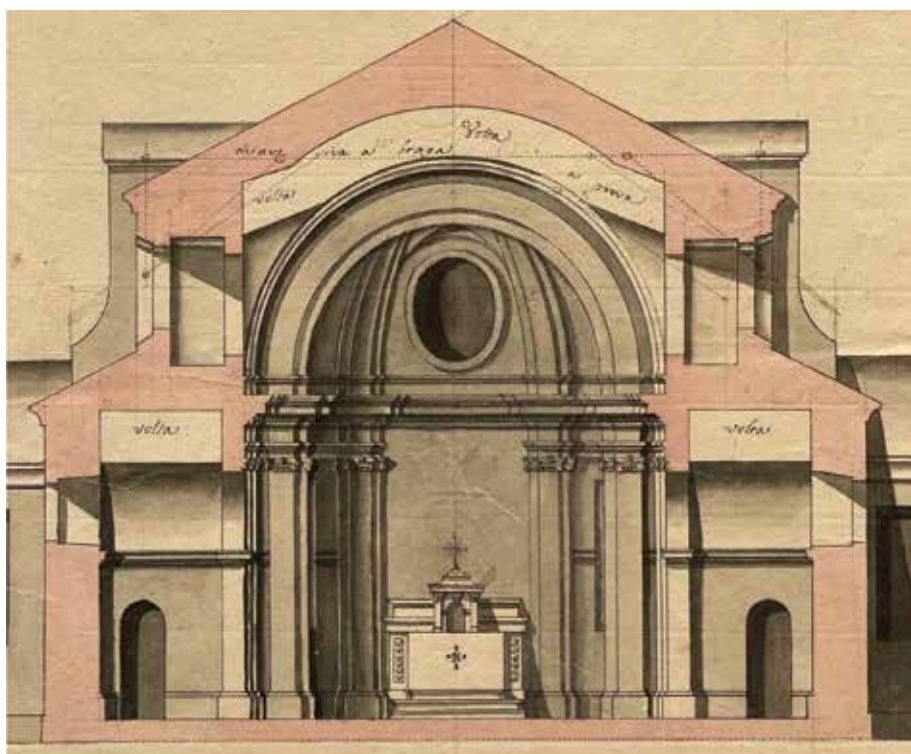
Dettaglio sezione trasversale della chiesa con prospetto dell'altare secondo disegni del Pinto, ISCAG, Brunetta, Cartella LIX A, nr. 3708.
